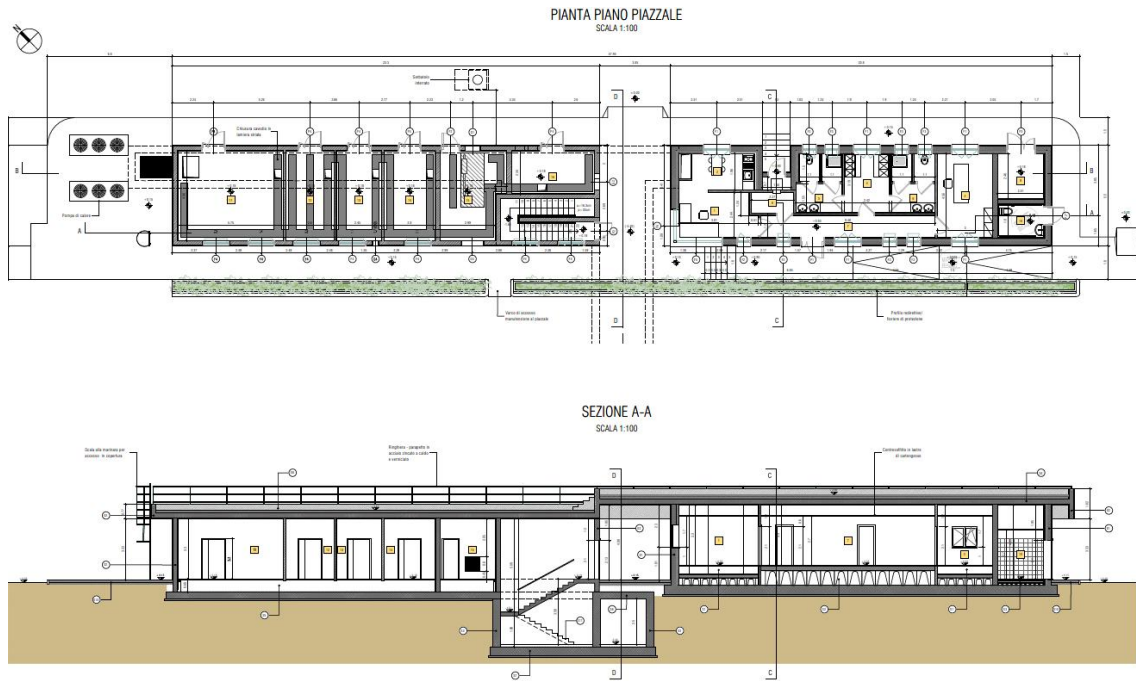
Pianta e sezioni longitudinali dei fabbricati
